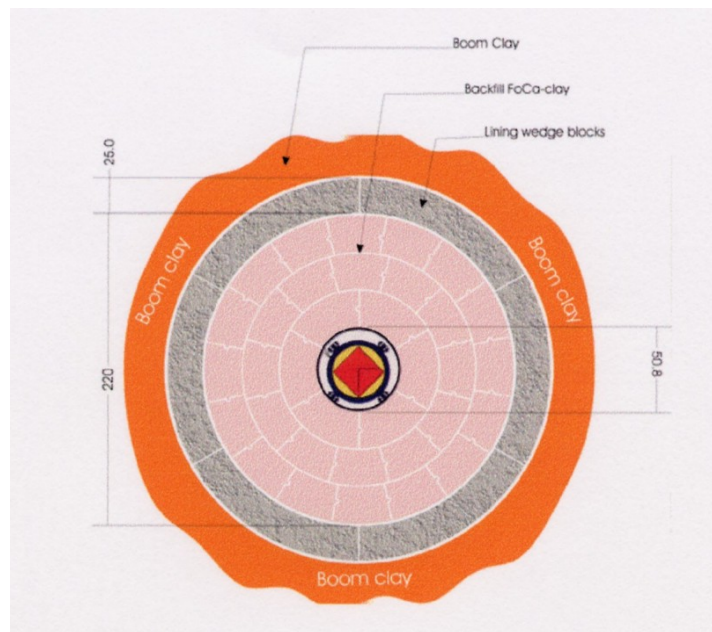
Schnitt einer Einlagerungsstrecke für ausgediente MOX-Brennelemente /2-5/
